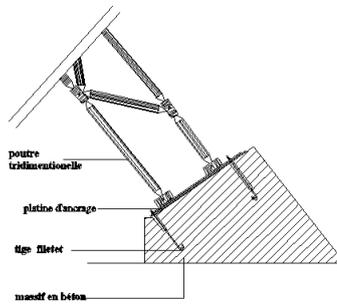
assemblage Poutre tridimensionnelle – socle béton armé (J)
